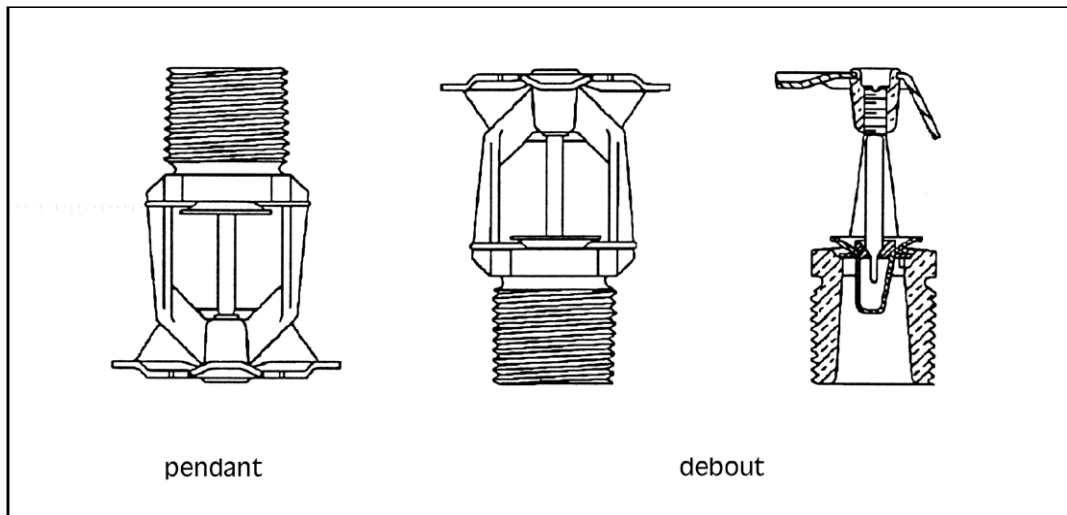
α : Sprinkleurs muraux verticaux
